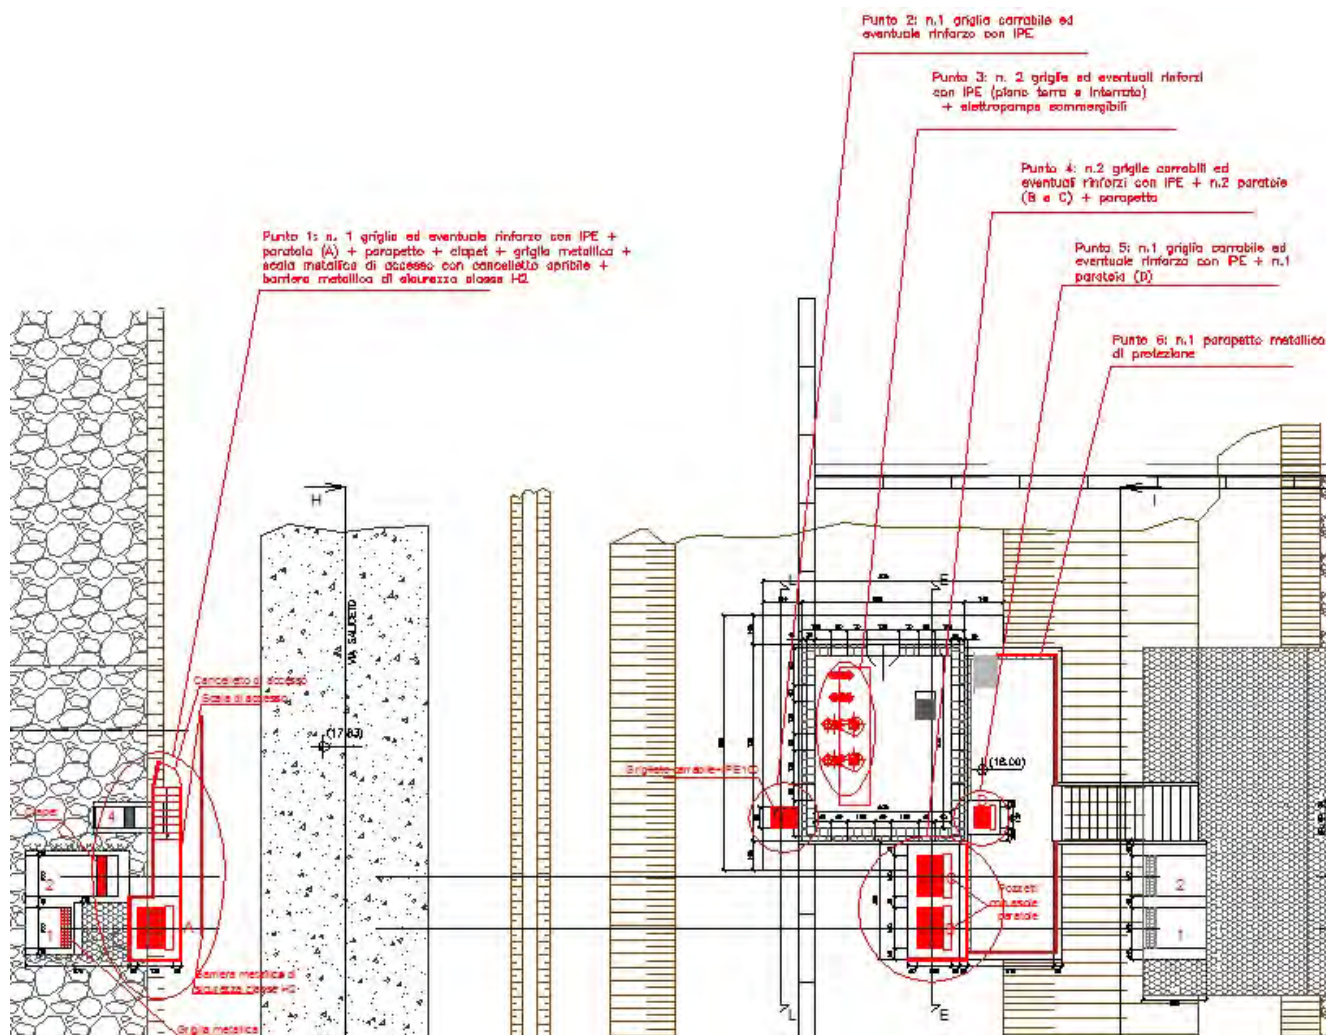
Planimetria manufatto di scarico, con indicate la collocazione delle griglie in progetto.
